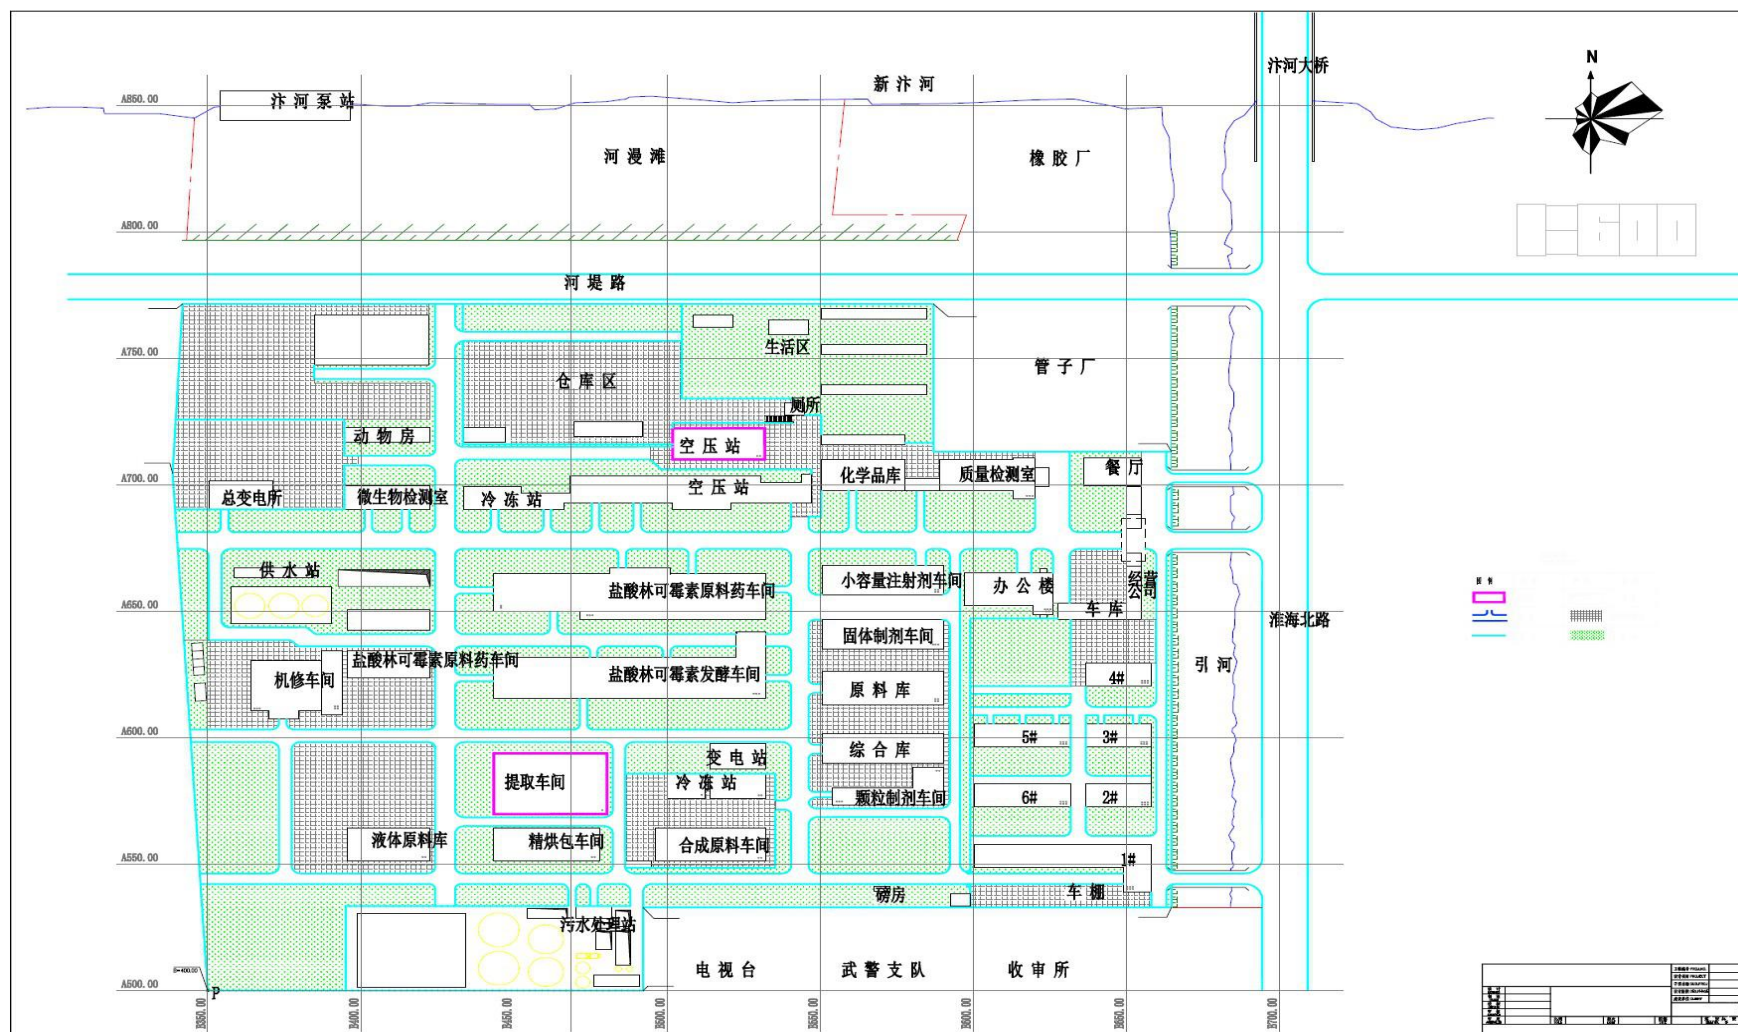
新宇药业股份有限公司淮海路厂区平面布置图
